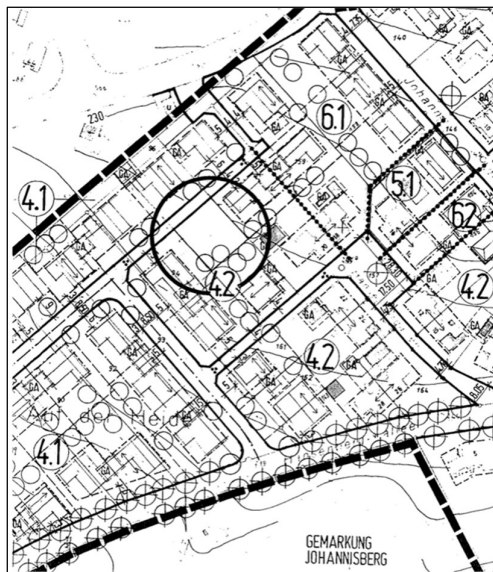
1. Änderung des Bebauungsplans „Hansenbergallee“, 2001 (Quelle: Hochschulstadt Geisenheim)
